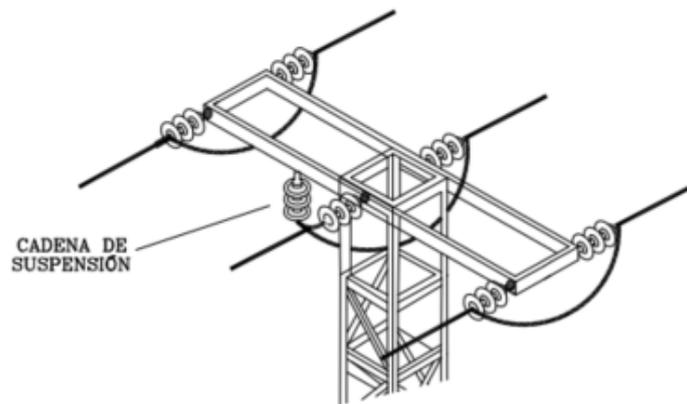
Vista isométrica del apoyo con aislador rígido sustituido por cadena de suspensión
